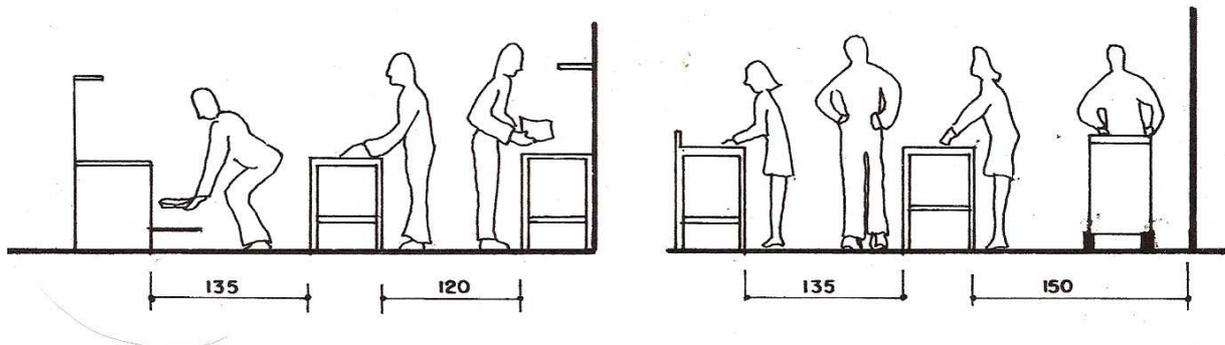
ESPAÇAMENTO ENTRE PLANOS DE TRABALHO. FONTE: SILVA FILHO (1996)
